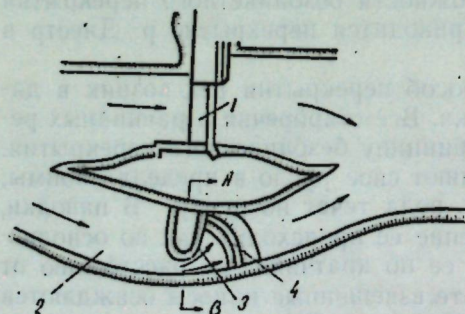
Схема перекрытия р. Днестр в Дубоссарском створе (план, разрез):
